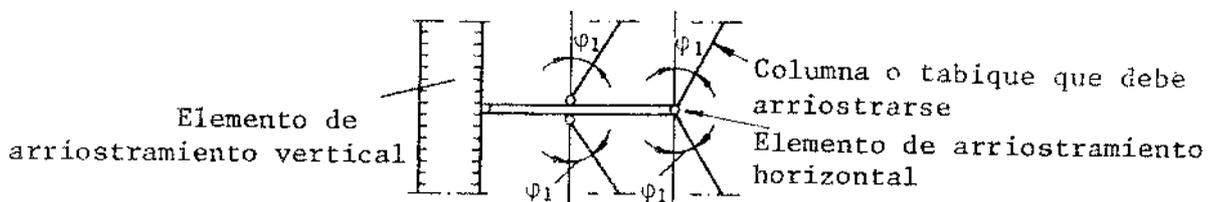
Inclinación ϕ_1 de todas las columnas y tabiques arriostrados
